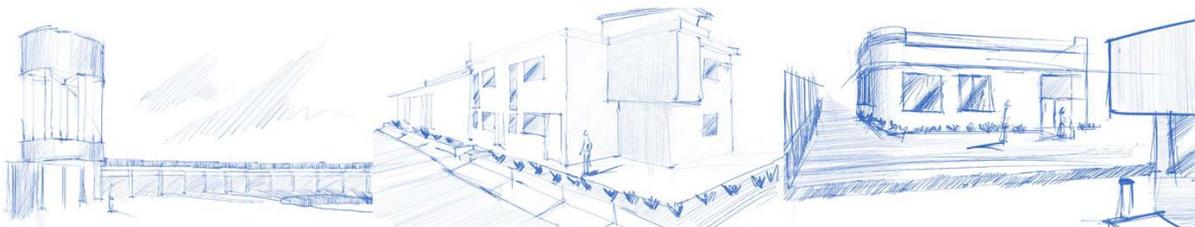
Tipología constructiva del conjunto histórico. Fuente: Elaboración propia
